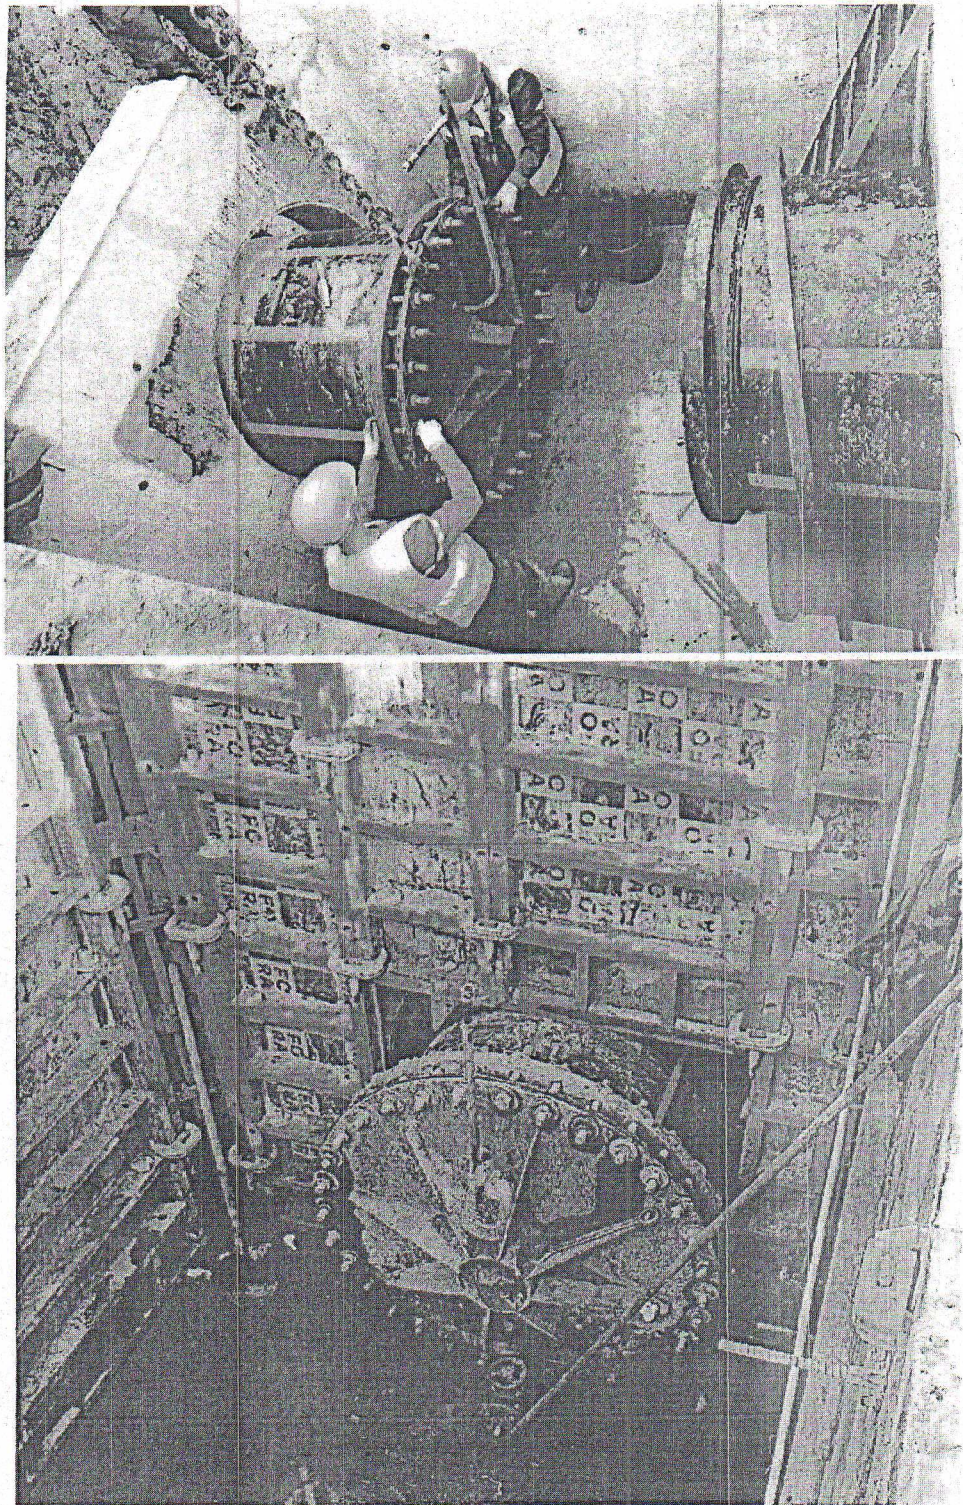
Общий вид и процесс установки заглушки на фланцевом соединении
